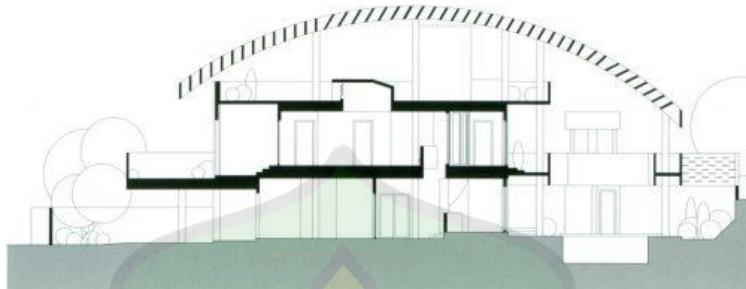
31 Gambar Lay Out Plan *The Roof-roof House
